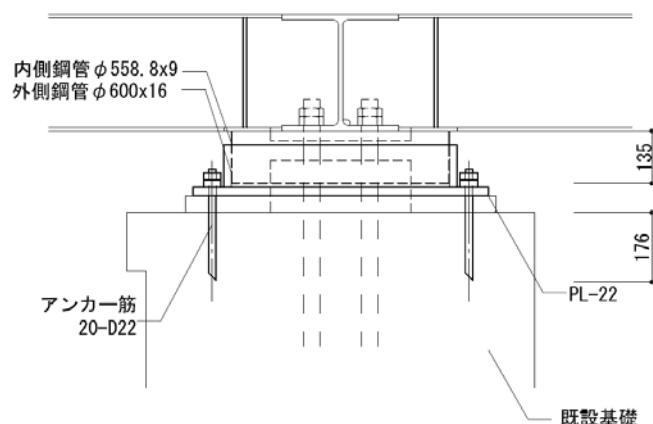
補強鋼管とあと施工アンカ一詳細 (断面図)
